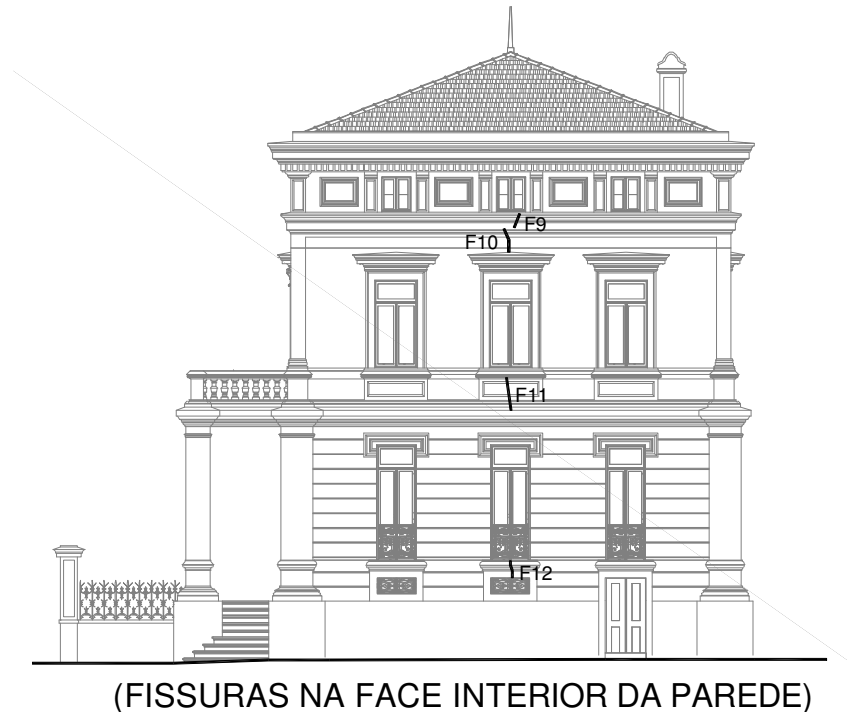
Fachada nascente: Localização de fissuras
